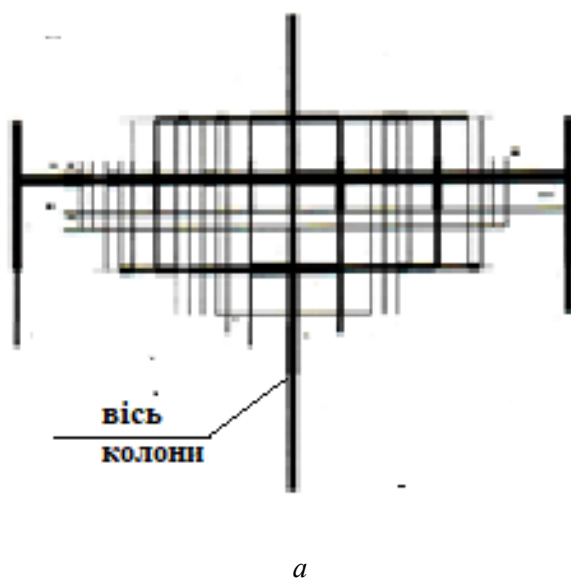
Механізм руйнування залізобетонних монолітних безбалкових плит перекриттів каркасно монолітних будівель від вибухових впливів:
